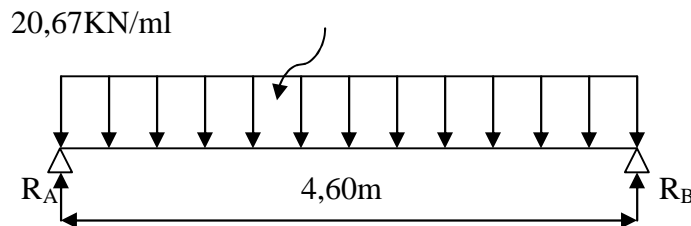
Schéma statique de la poutre palière.' ELS.
